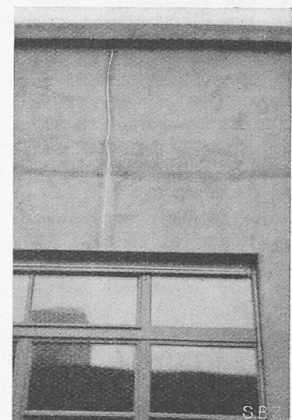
Riss in massiver Terrassenbrüstung, erkenntlich an beginnender Sinterung
